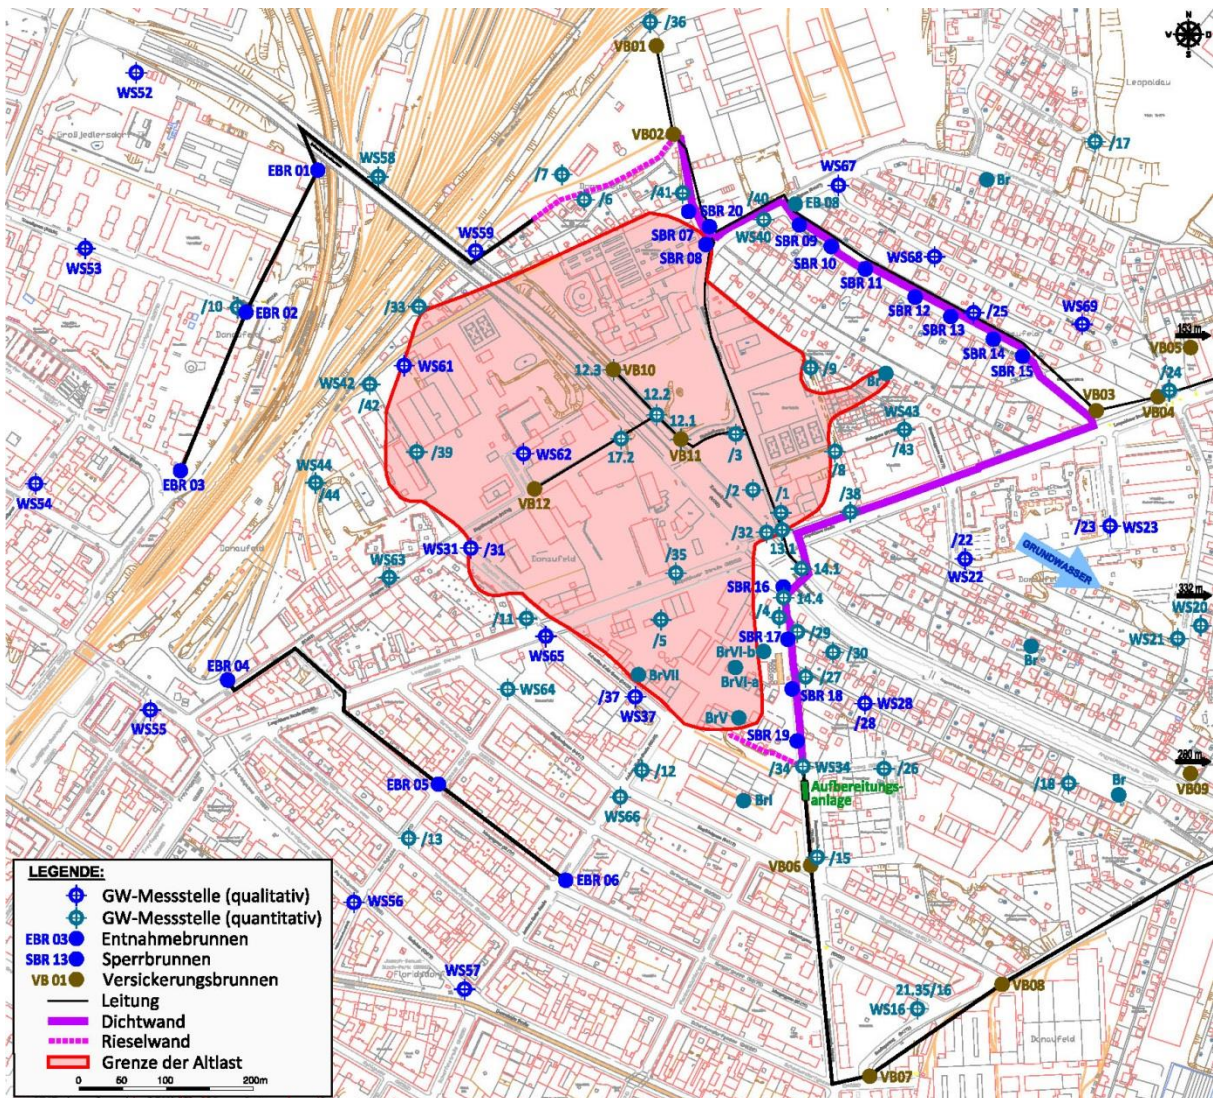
Lage aller relevanten Grundwassermessstellen und Bauwerke
